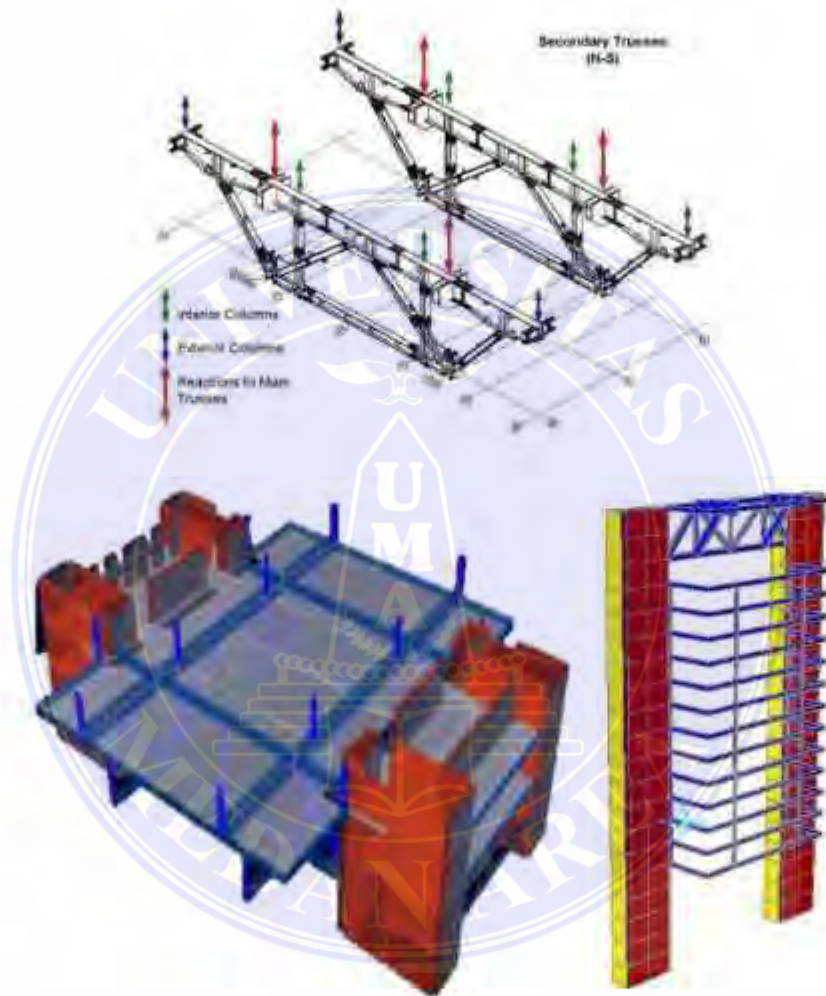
23 Denah dan Tampak Torre Cepsa
